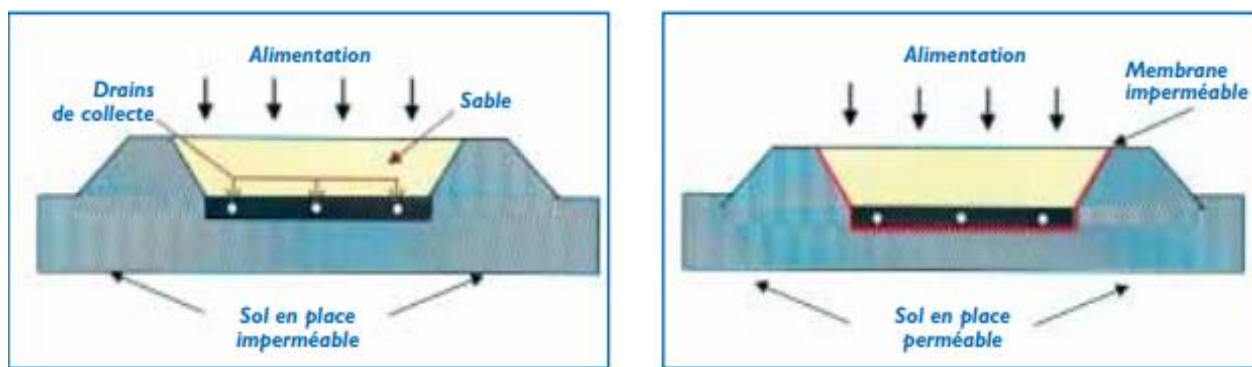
Système drainé sur sol en place imperméable et Système drainé avec un Massif drainant étanché par une membrane imperméable
